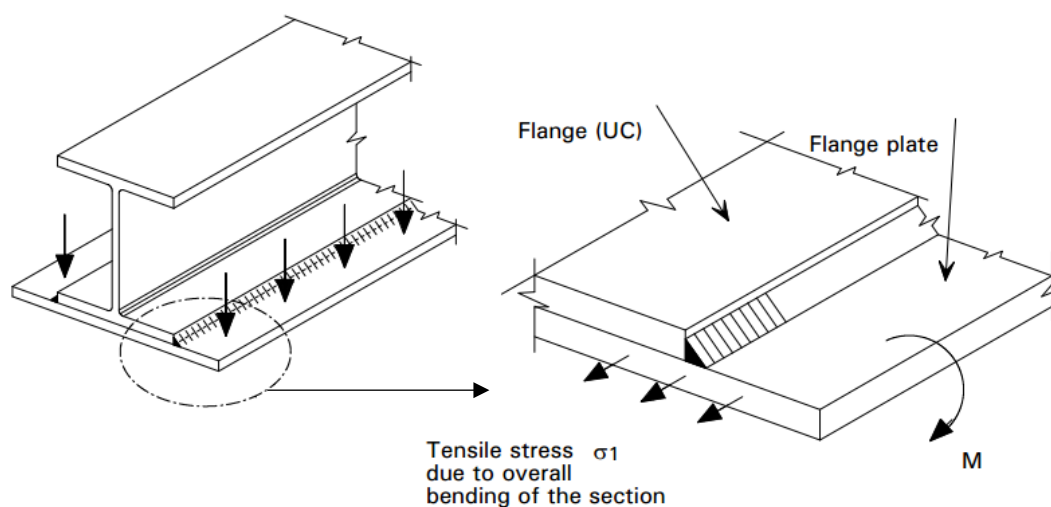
Estado biaxial de tensão na chapa soldada sobre o banzo do perfil metálico em soluções *slimfloor* (adaptado de Mullett e Lawson, 1999).
